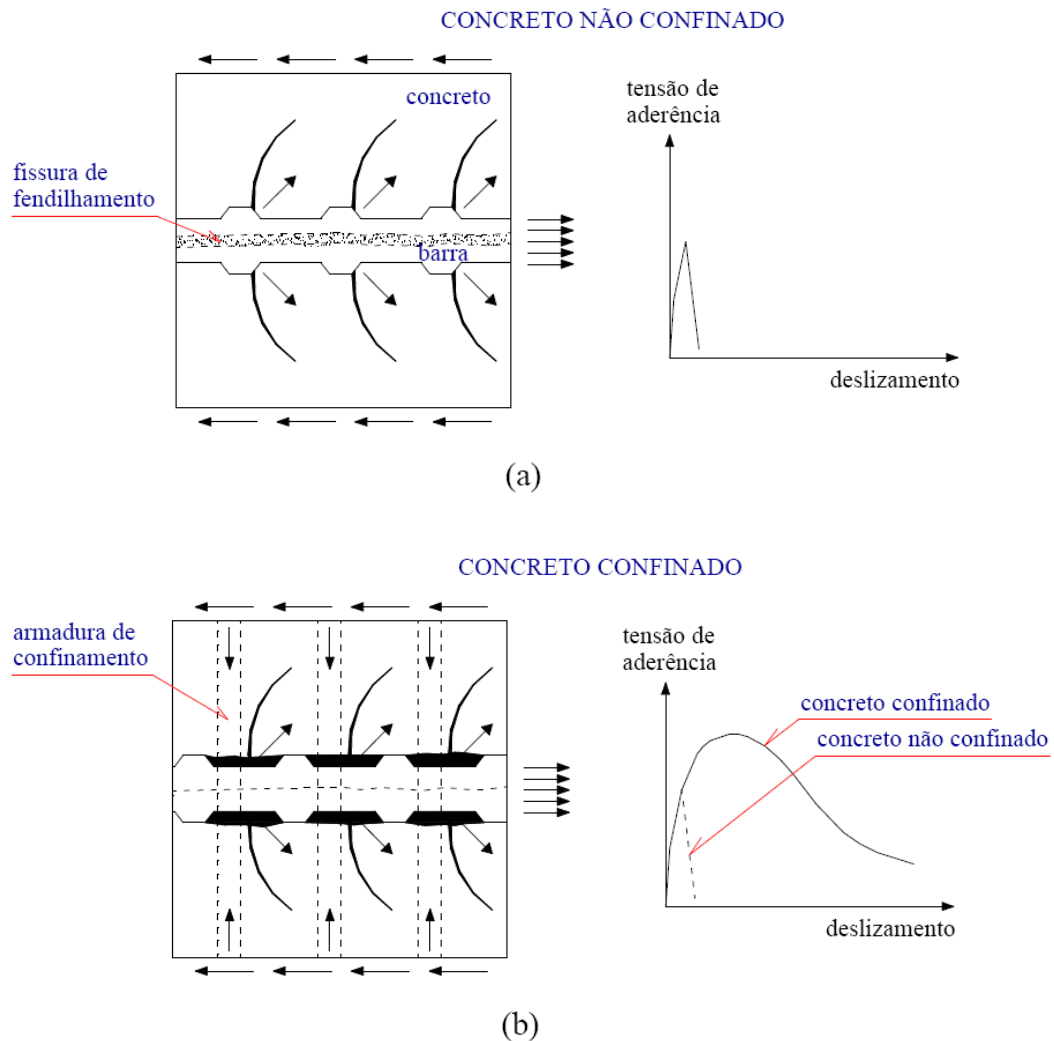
Ruptura da aderência por: (a) fissuração por fendilhamento em concreto não-confinado; (b) arrancamento em concreto confinado [Fernandes, 2000].
